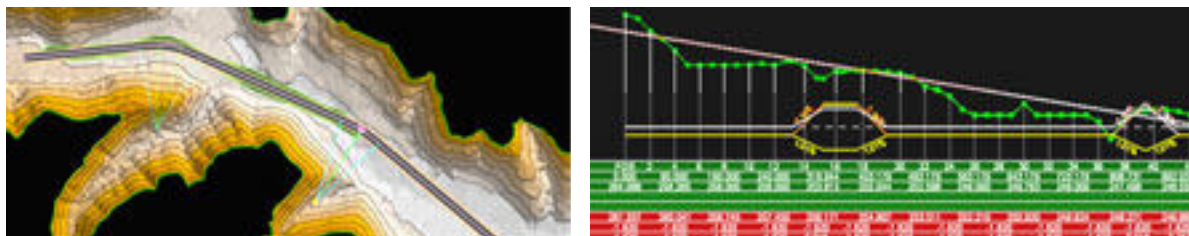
Lageplandarstellung zum Entwurf der Achse (links) und Höhenplan zur Darstellung von Gelände- und Trassenhöhe sowie Krümmung an Stationen der Achse (rechts) [3]
